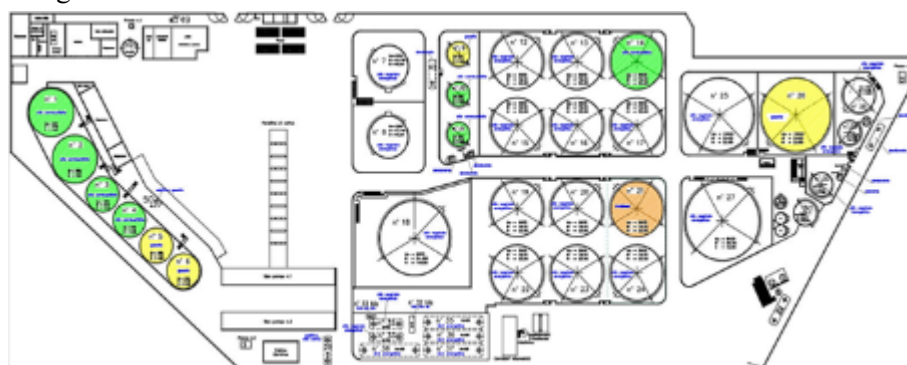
Planimetria dello stato di fatto con indicazione dei 12 serbatoi operativi (colorati)
